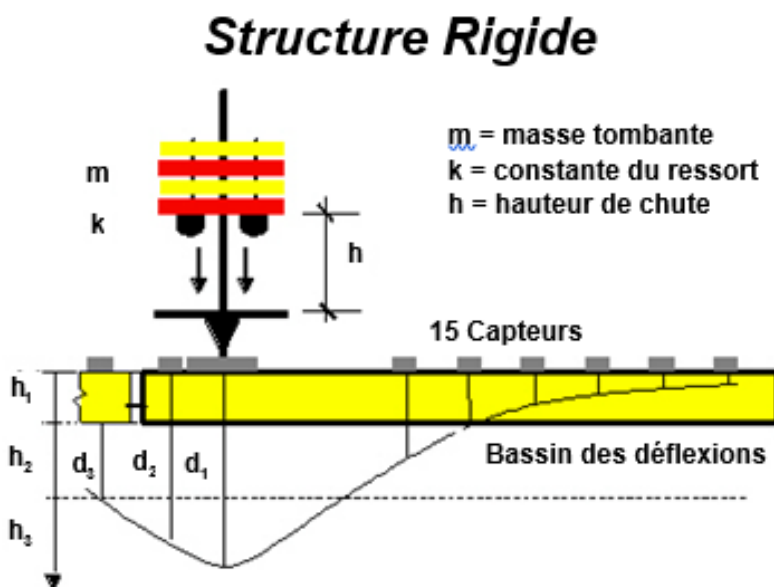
Principe de mesures du bassin de déflexions sur chaussées rigides
